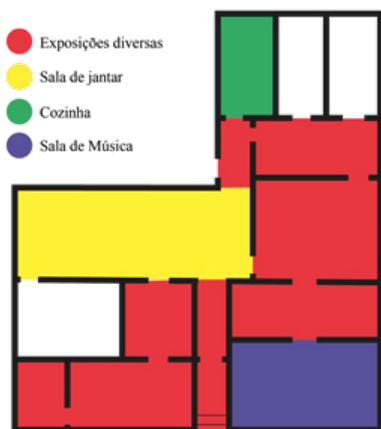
Esquema da planta térrea com a setorização dos itens expostos. Fonte: Autor, 2021.
